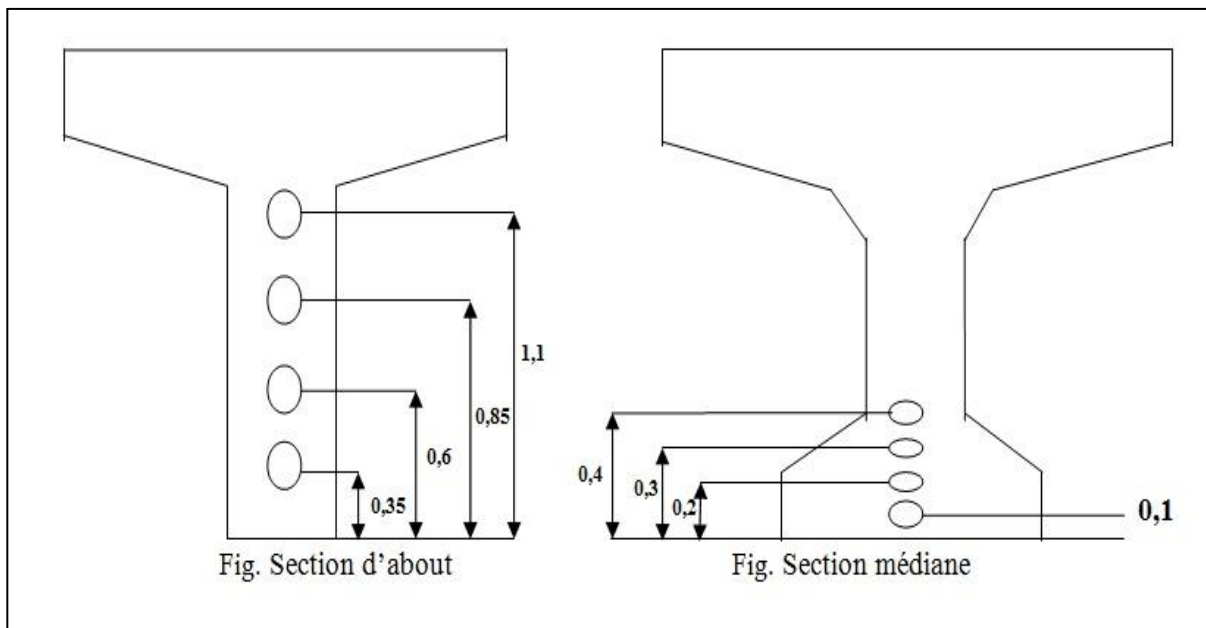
L'emplacement des câbles dans les sections des poutres.
